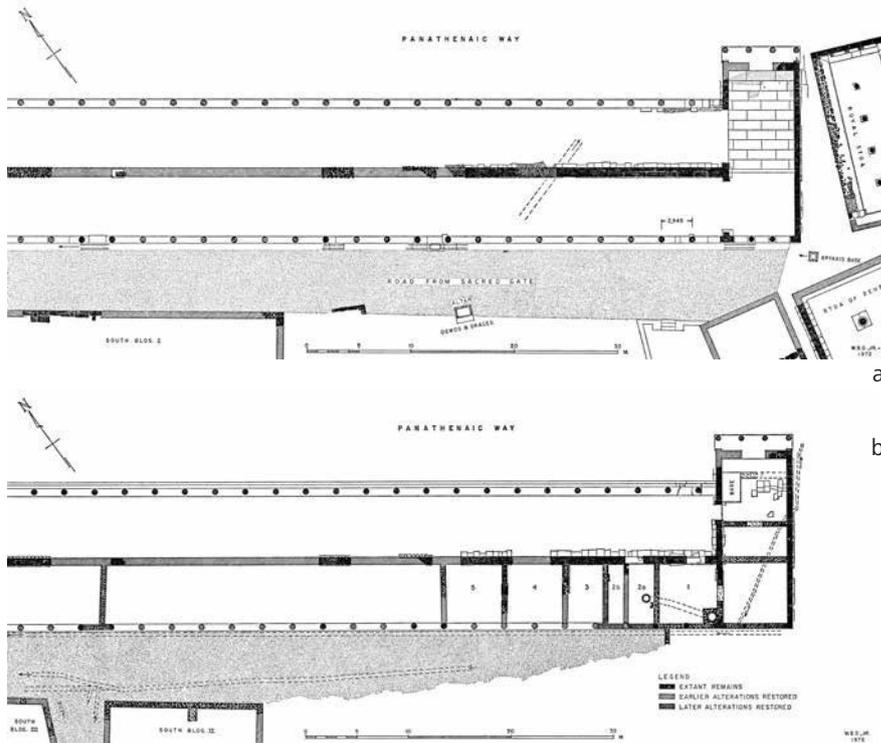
Grundriss der Stoa an der südlichen Seite der Panathenäenstraße:
